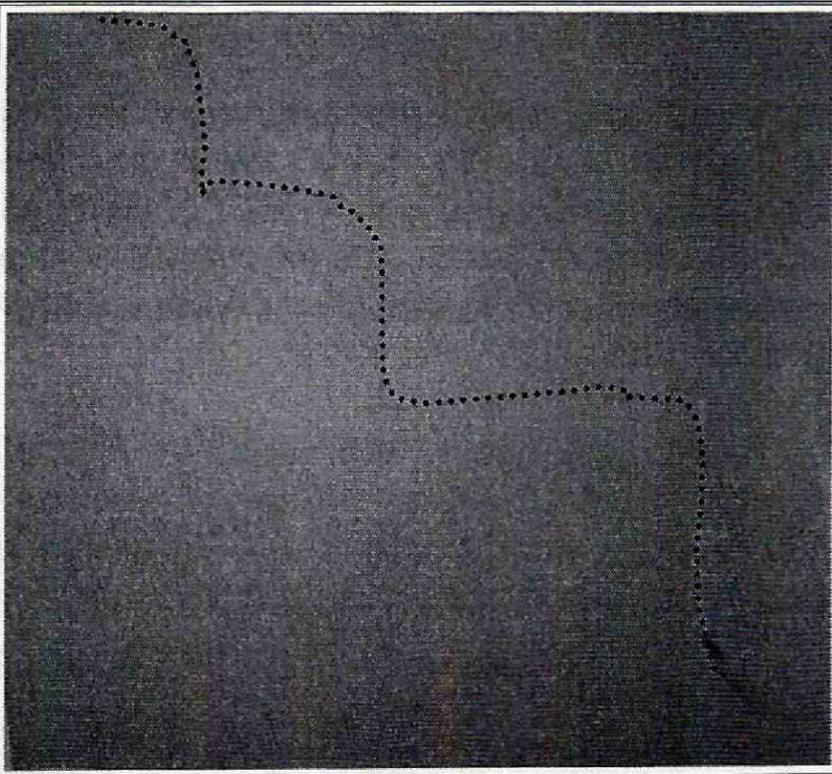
Fisura escalonada muro segundo nivel de la vivienda emplazada en el predio de la Calle 51 D Sur No. 4 – 01 Este
